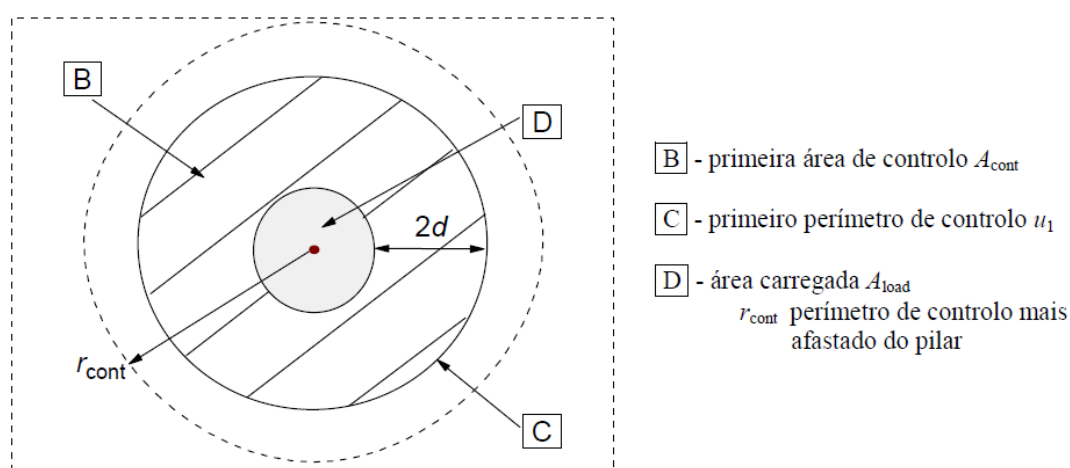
Modelo para a verificação do punçoamento no ELU - Planta
